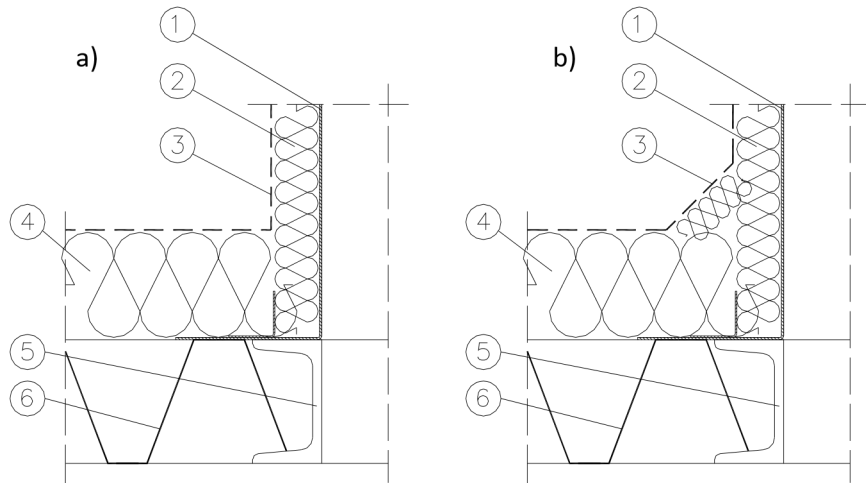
Стальное основание на стальной конструкции (а – обработка мембраной, б – обработка рубероидом)
